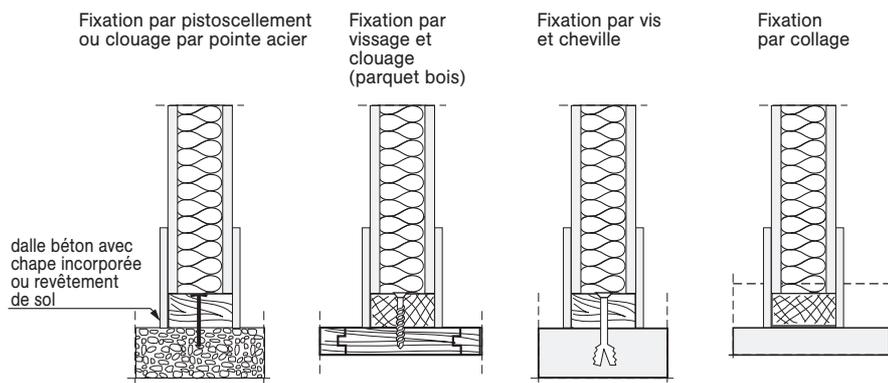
Coupes illustrant les solutions de fixation basse des panneaux de cloison en fonction du support de fixation
